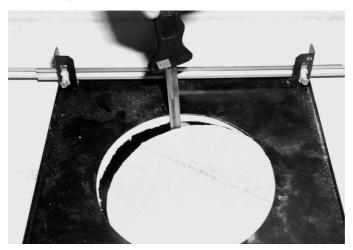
Découpe d'un trou dans la dalle de plafond
